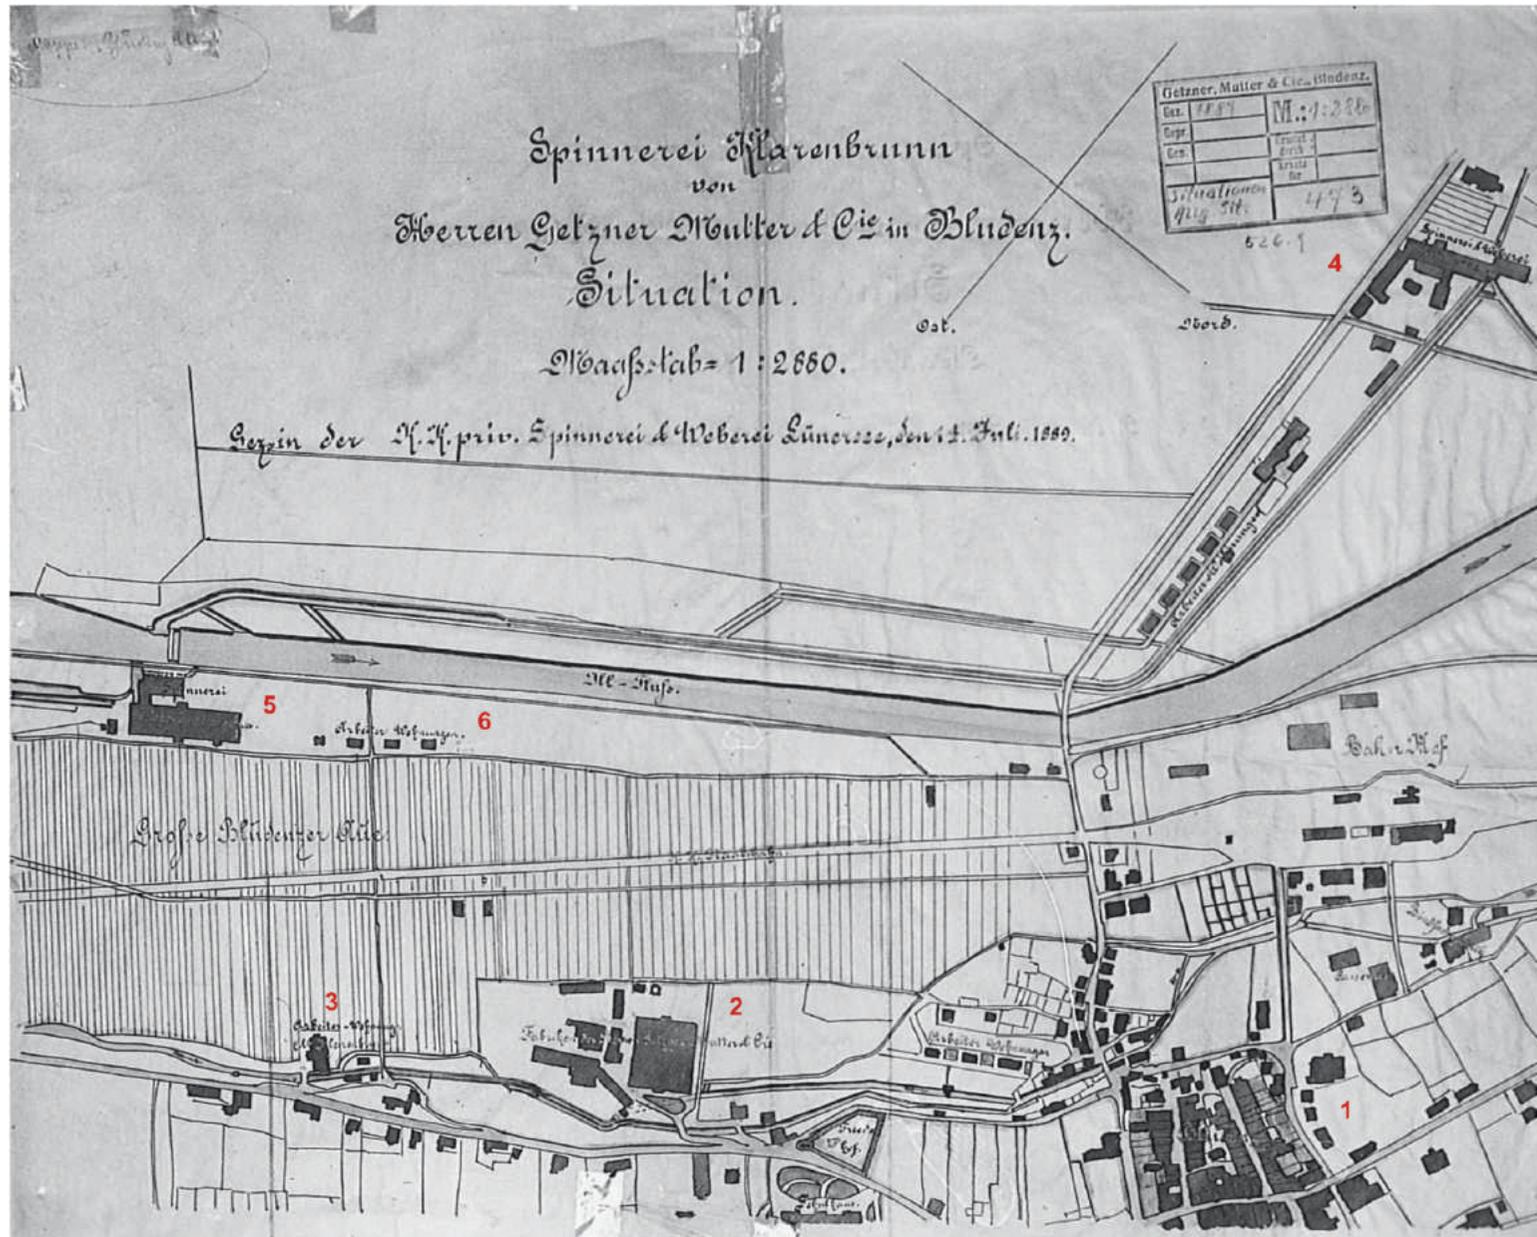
Situationsplan mit allen Standorten von GMC (Bleiche, Lünersee und Klarenbrunn), Altstadt von Bludenz, Wasserkanalanlagen zu den Standorten, Juli 1889
